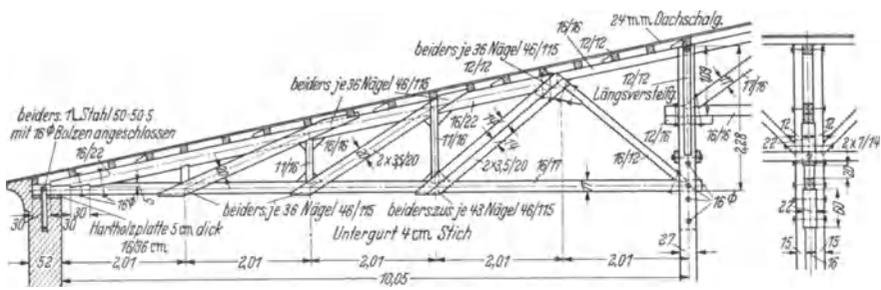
Messehalle 4 in Leipzig. Binderkonstruktion des linken Seitenschiffs.
